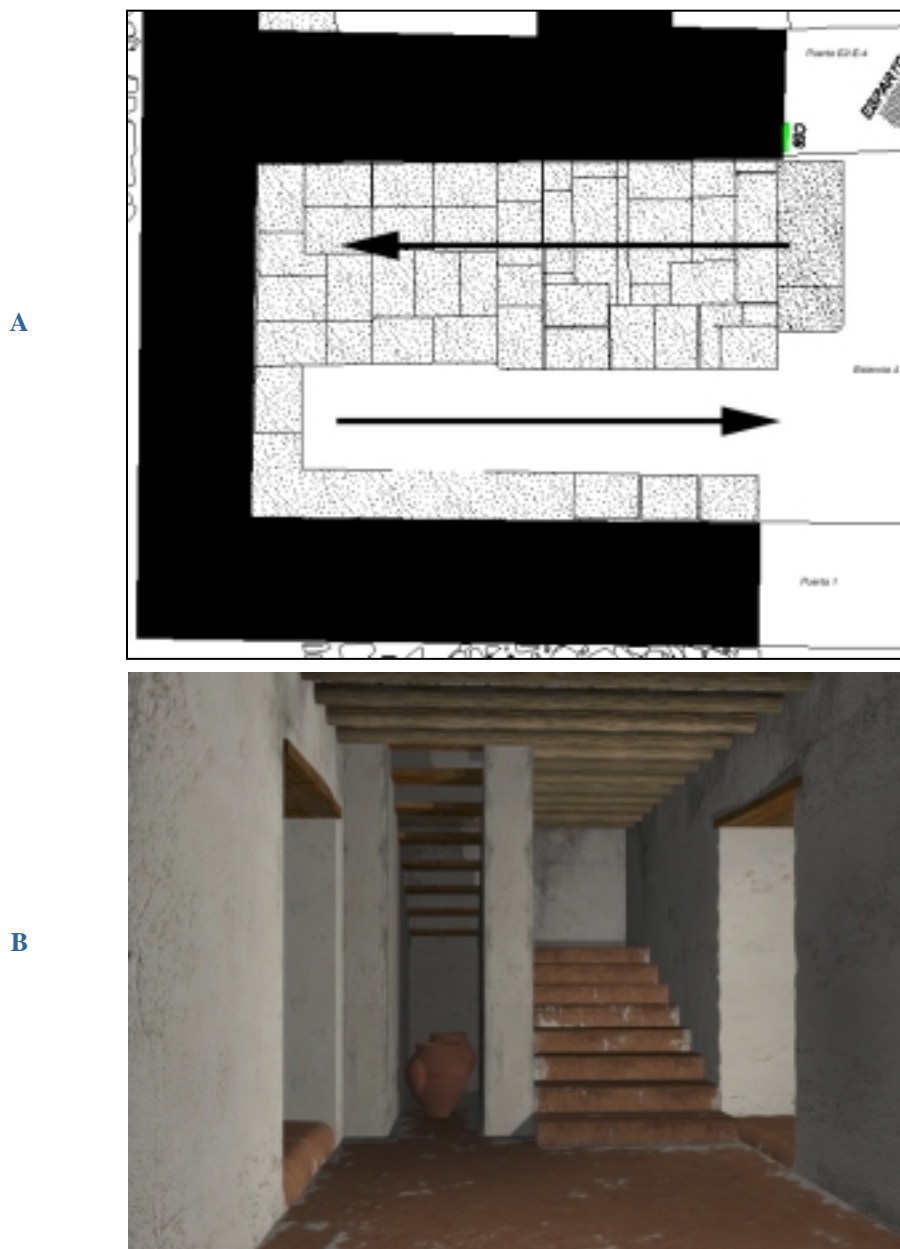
Planta parcial (A) y recreación de las escalera de acceso a la segunda planta propuesta para la musealización de La Mata (B).
